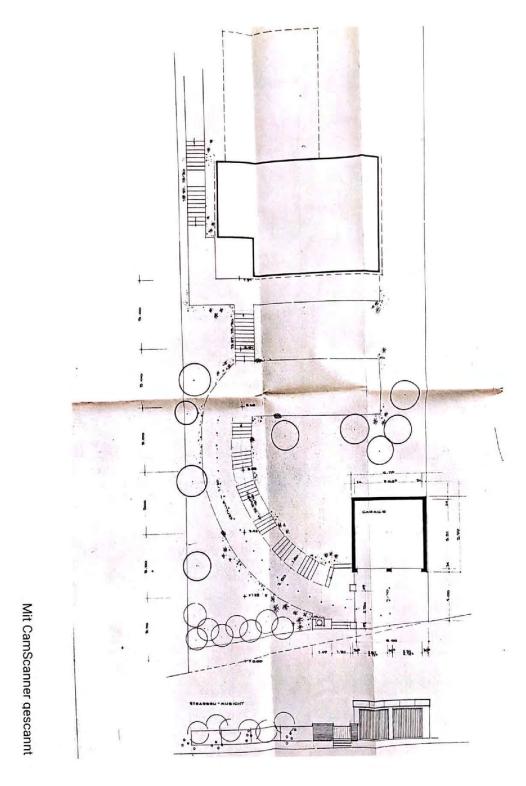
Grundriss Wohnhaus mit Garage
